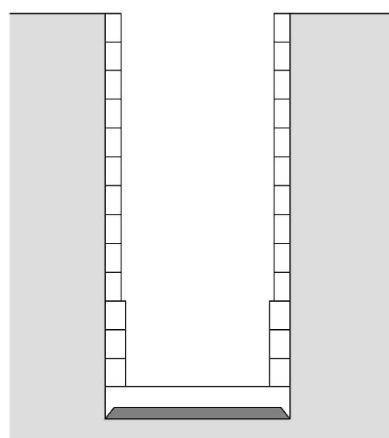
非常口の施工概要（ケーソン工法の場合）
